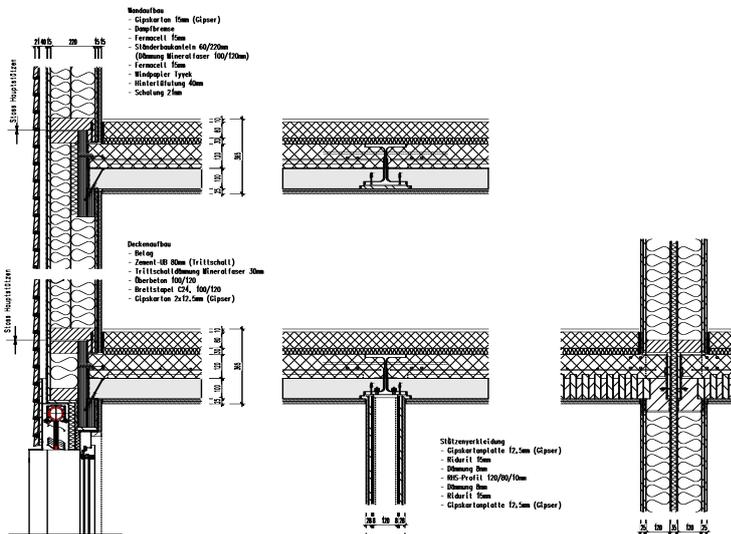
Auf dem Skelett-/Rahmenbau aufgebaute Standarddetails in Kombination mit Stahlträgern als Unterzugsystem und mit Holzbetondecken.
